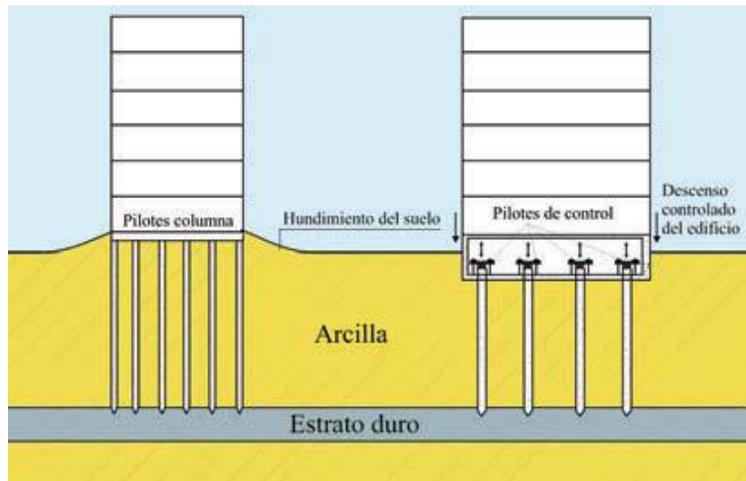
Ejemplo de cimentaciones realizadas con pilotes columna y pilotes de control.
